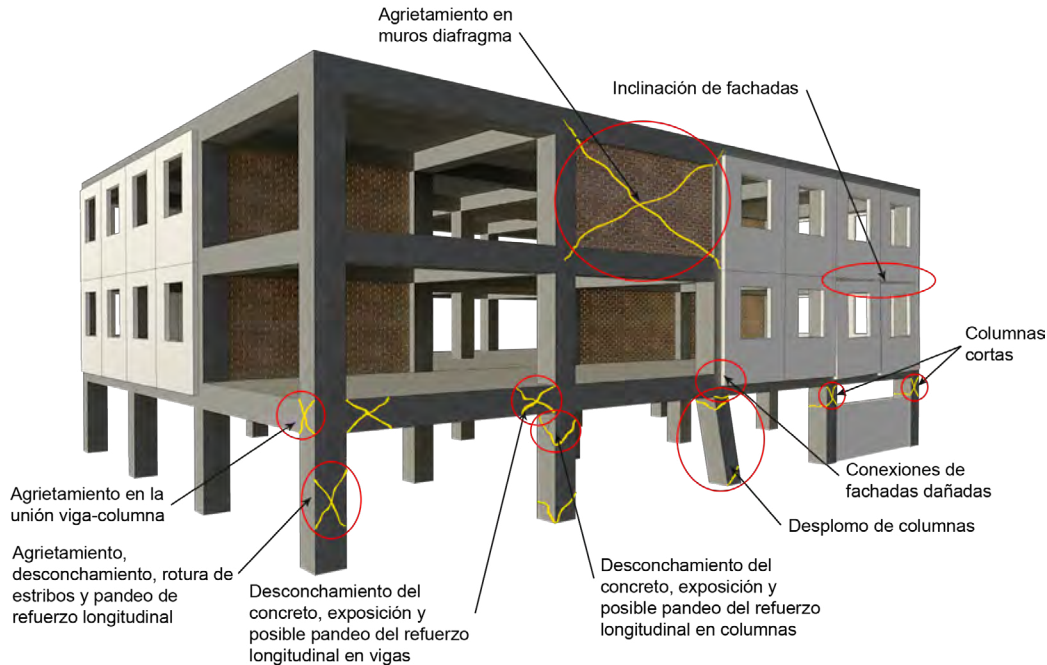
Zonas dañadas comúnmente encontradas en edificios de marcos de concreto.
